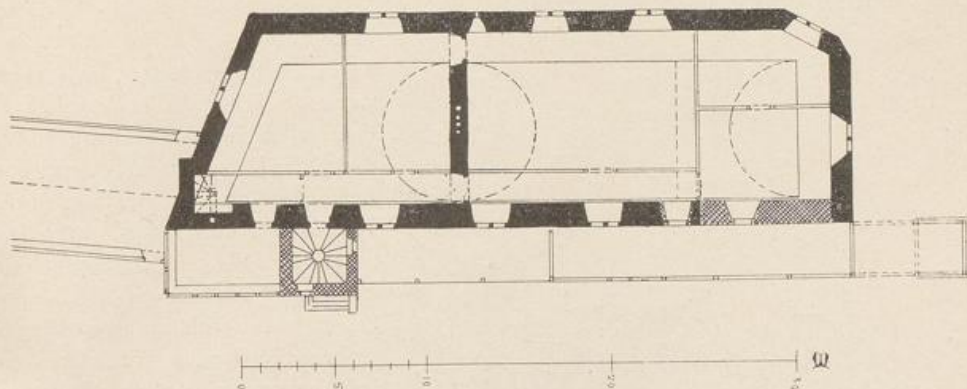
Grevenbroich. Grundriss des Schlosses.
